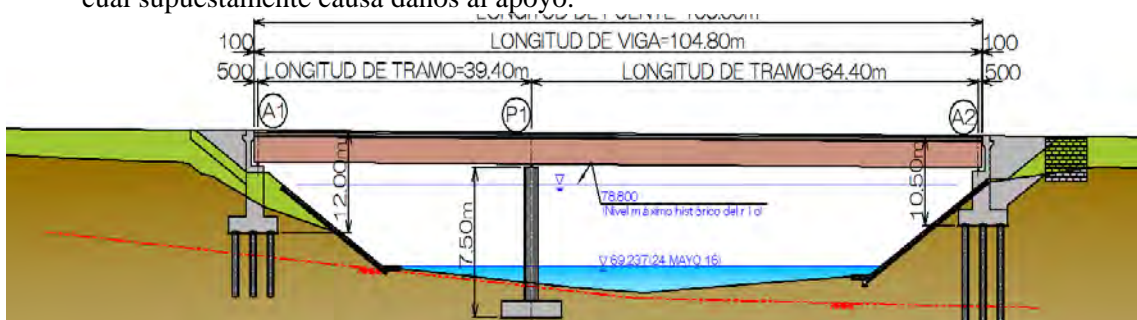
Obra de prevención de socavamiento de la pila del Puente Labú
